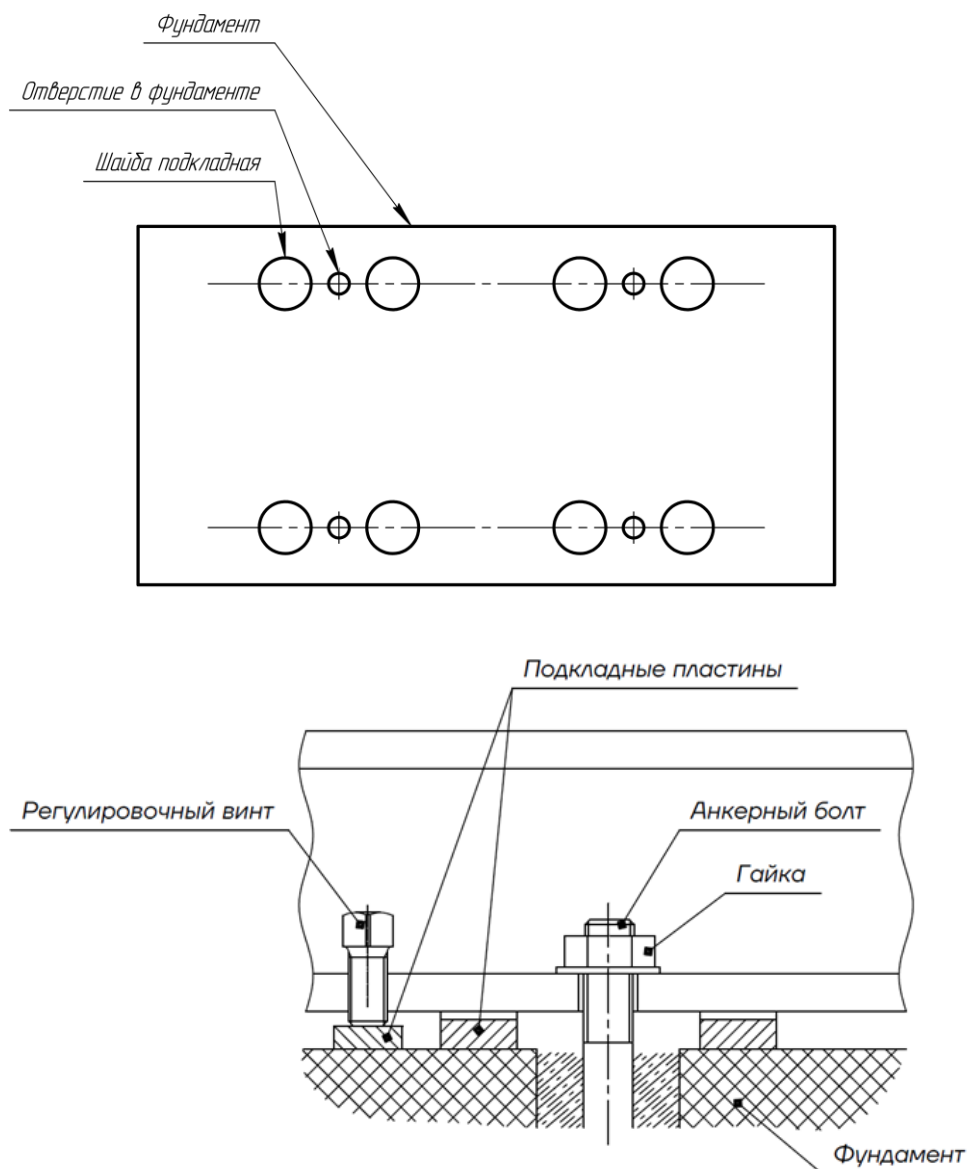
Схема расположения шайб на фундаменте (вид сверху).
